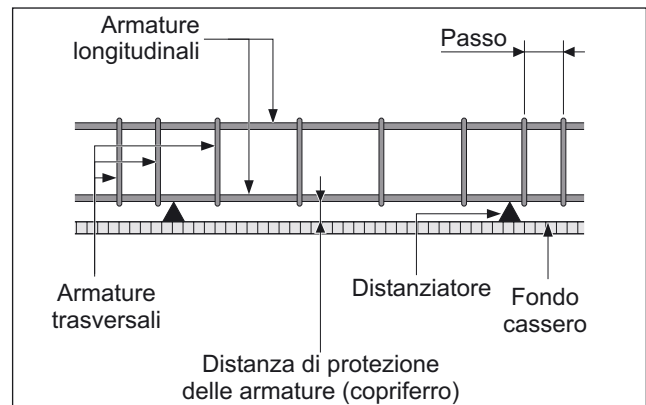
Sistemazione delle armature longitudinali rispetto alla cassaforma.
